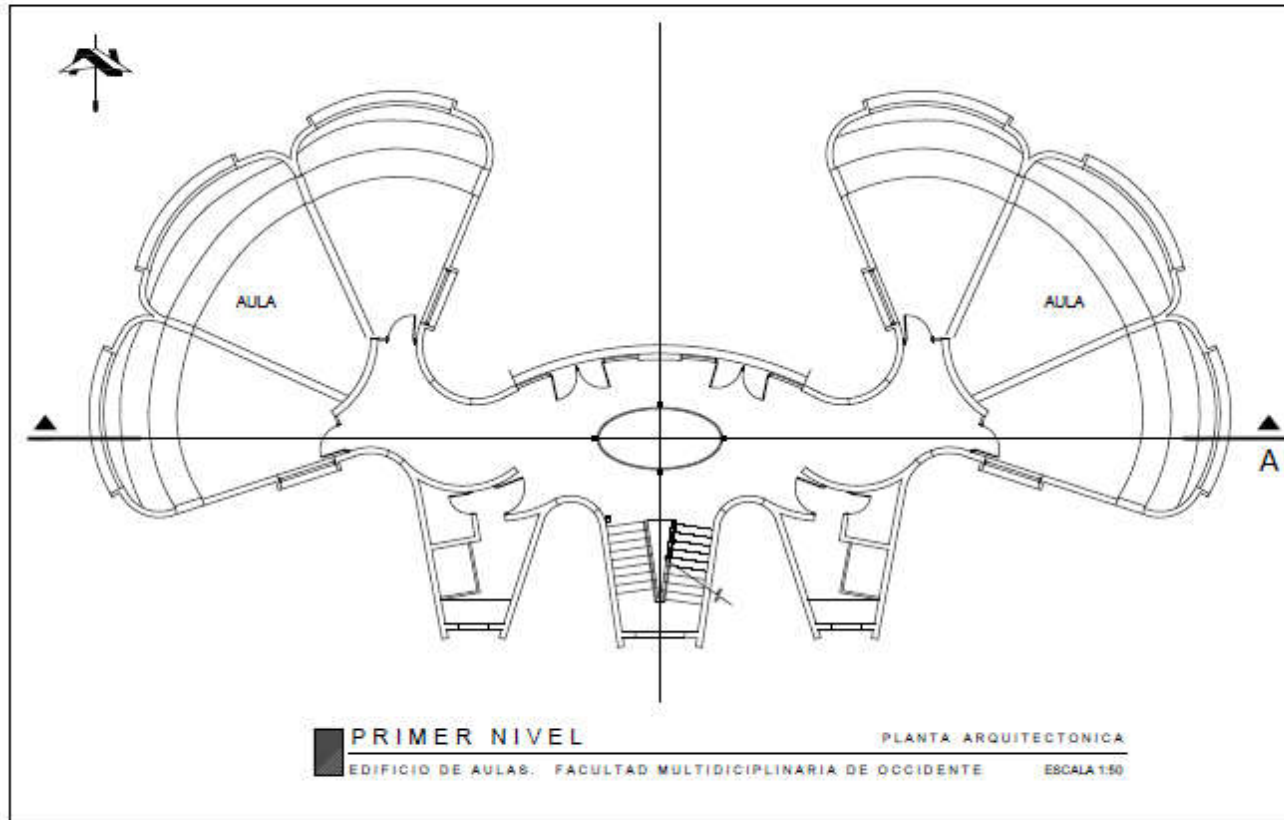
Planta arquitectónica del primer nivel del Edificio Bunker
